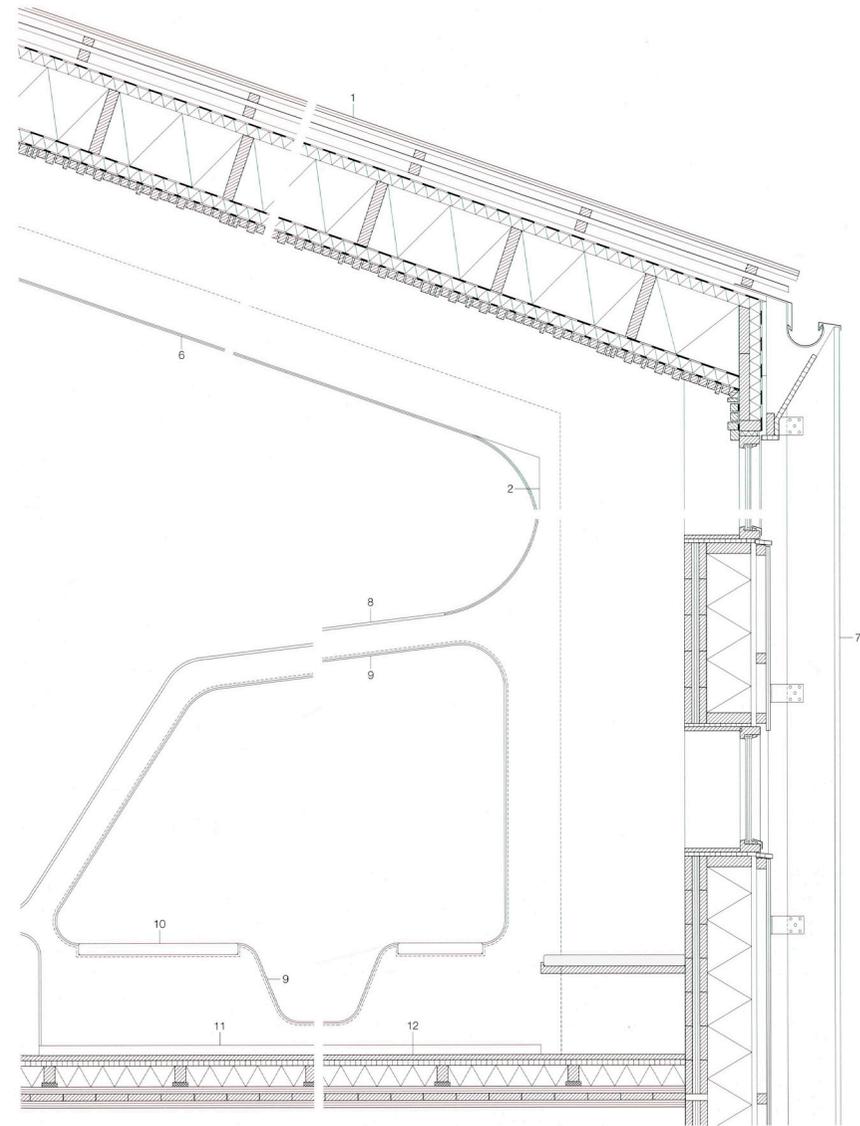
Detalle constructivo, sección transversal. Fuente: Schittich, C., Lenzen, S., Dondelinger, M., Kohl-Kastner, A., Leitte, S., Meyer, K., Schönbrunner, Eva., (2014), HOLZ = WOOD, Munich, Alemania: DETAIL.
